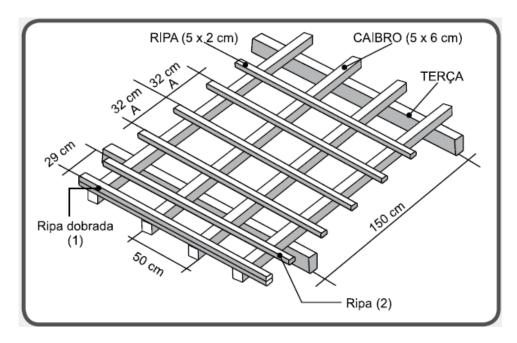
Esquema da Trama de Coberta de telha de Concreto Fonte: NBR 13.858- 1
